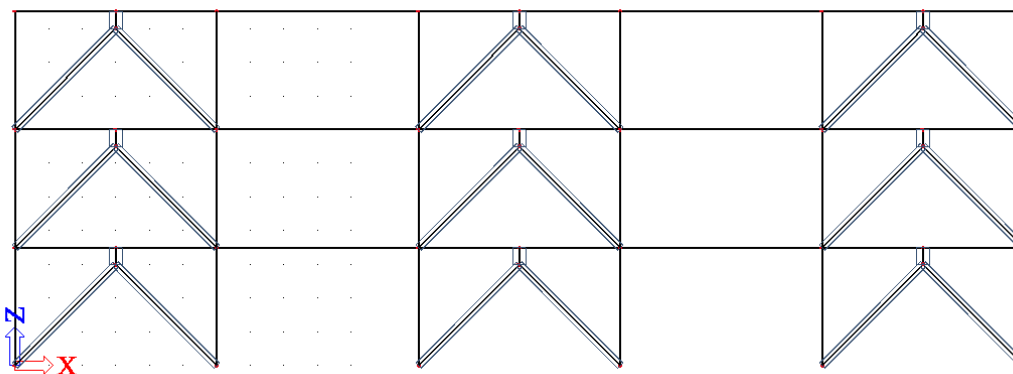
Geometria excentrického stužidla – 3-podlažný rám – varianta 1
